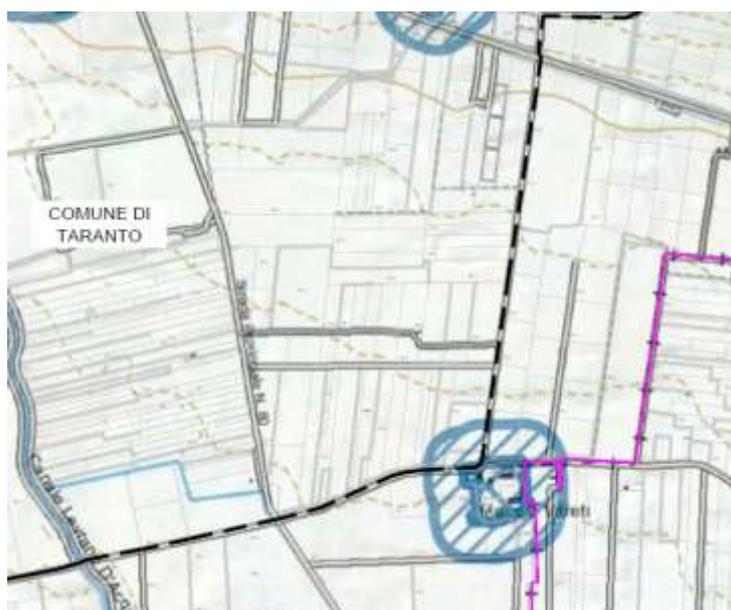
Particolare tratto di cavidotto su strada esistente che intercetta fascia di rispetto masseria Vitreti Tavola 6.3.1
